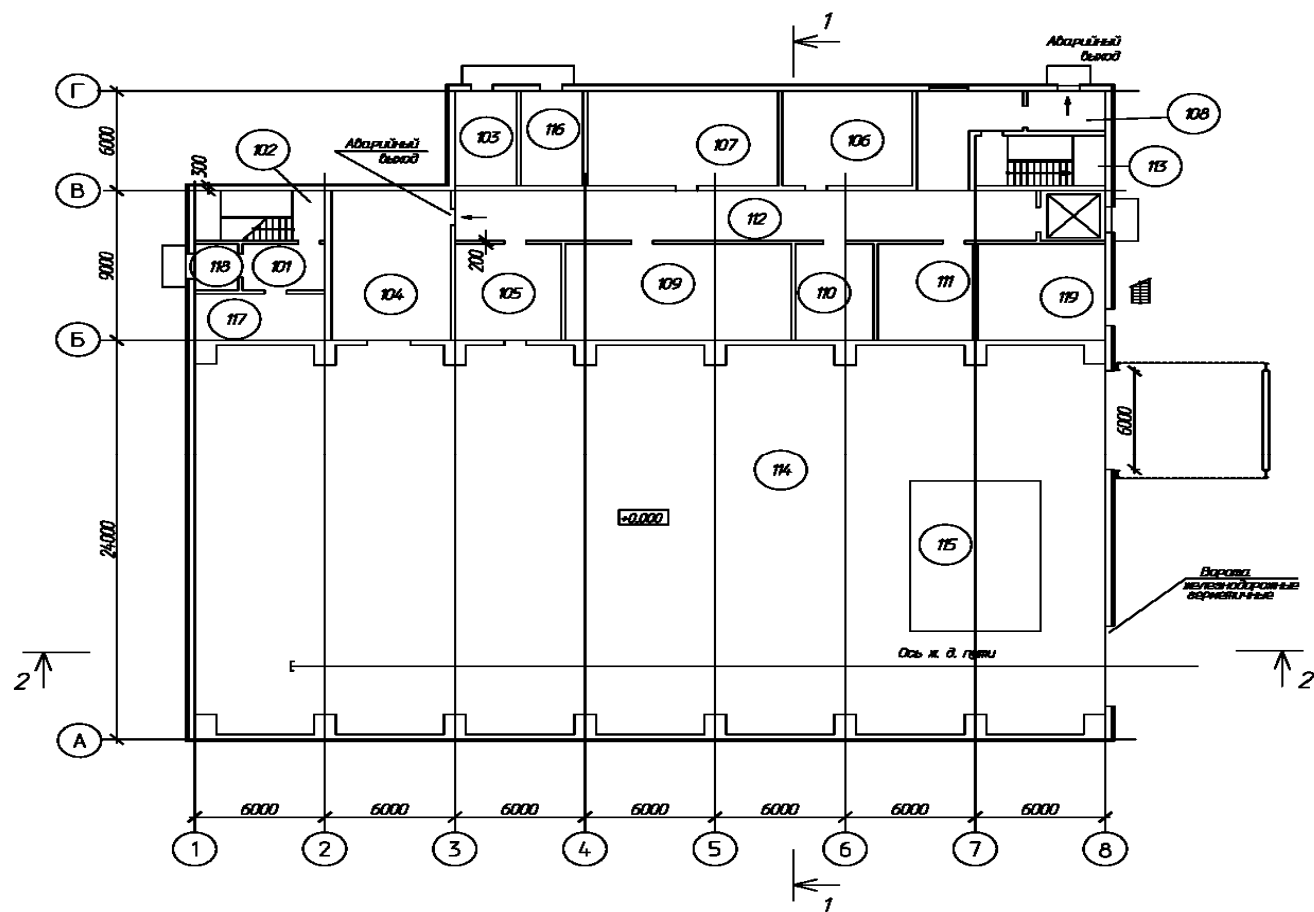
Здание приемки. План на отметке 0,000
